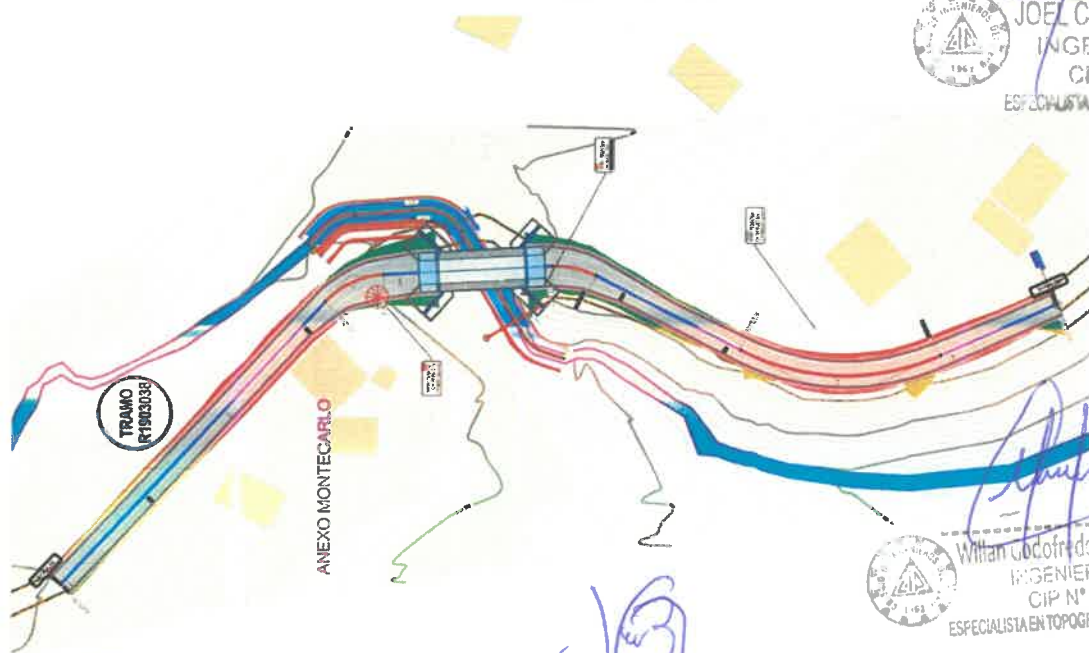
Planteamiento del proyecto – Puente Montecarlo
